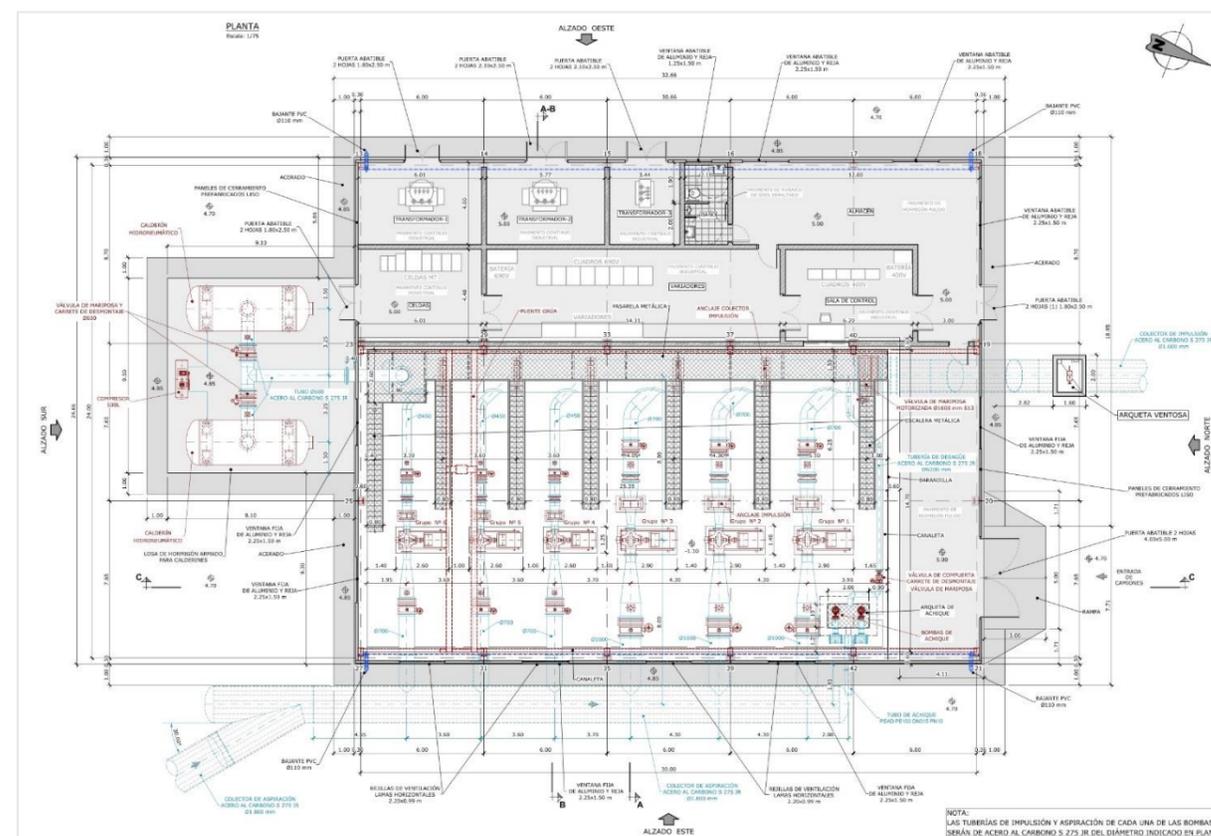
Planta de la estación de bombeo a riego. Sector Palmillas
